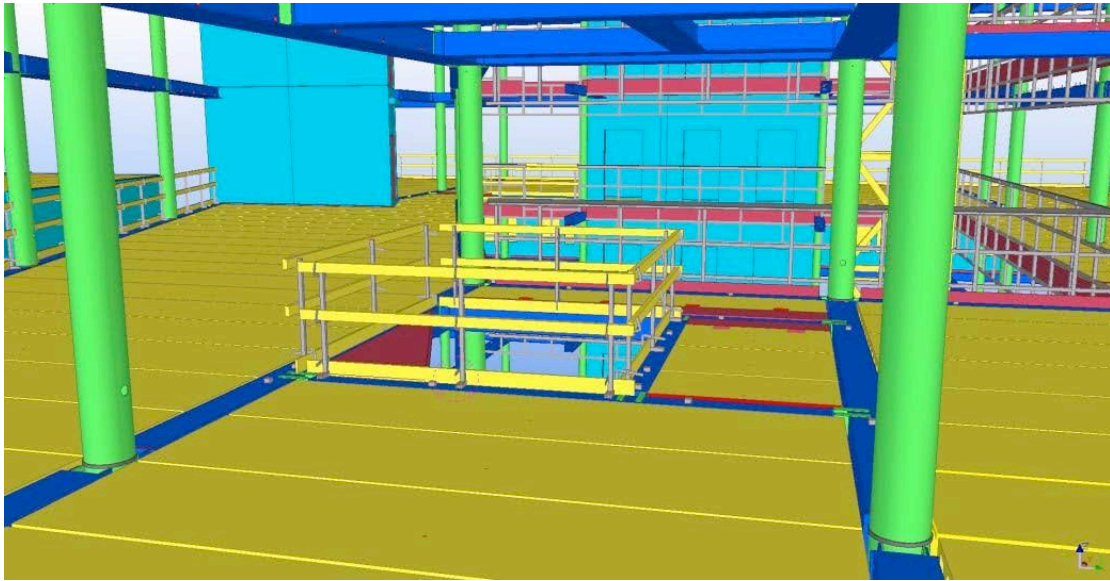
Un ejemplo de un plano de barandilla de seguridad basado en BIM modelado en una planta de un modelo estructural. (Fuente: VTT, Skanska)
